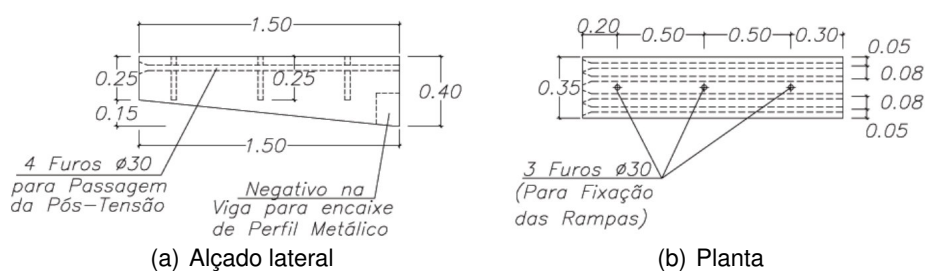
Pormenor de ligação rampa-pilar de extremidade [14].
